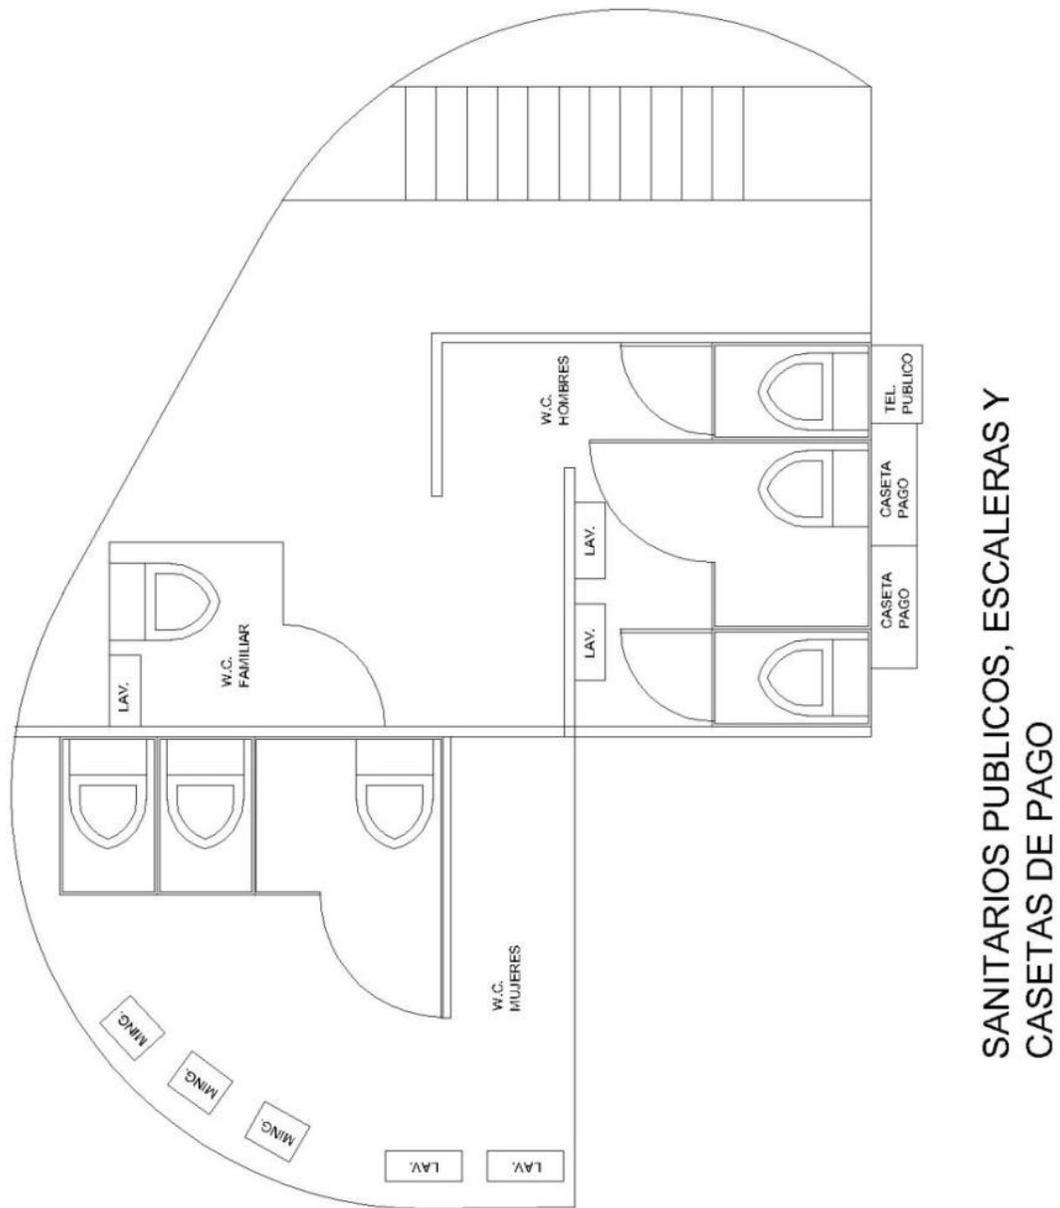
Dibujo arquitectónico de planta baja de edificio “D” (fuente: dibujo hecho por el autor).
